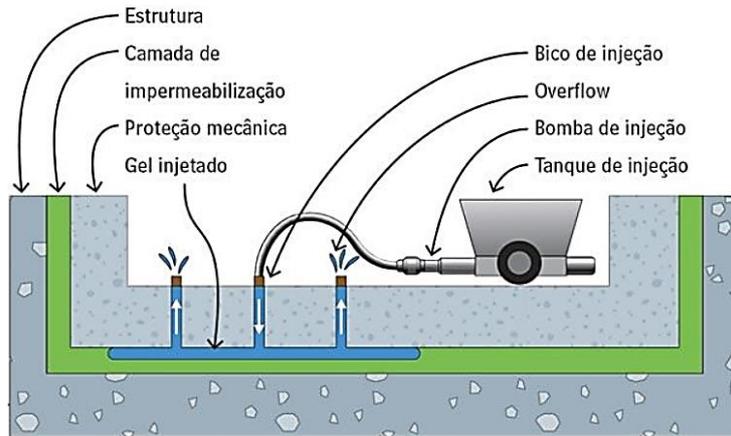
Injeção de impermeabilizante em laje. Fonte: CICHINELLI (2013)
